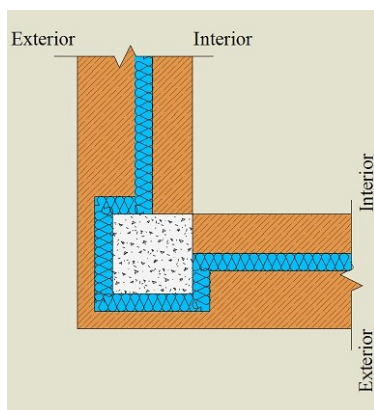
Exemplo de um pormenor construtivo para aplicar na proposta – pontes térmicas .
